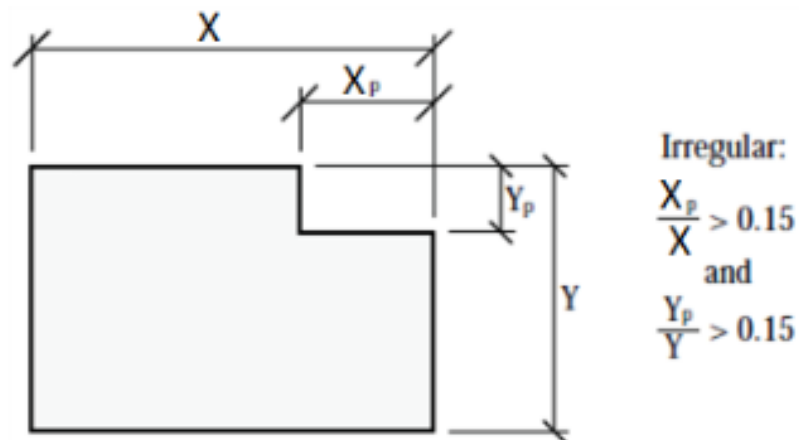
Esquema de irregularidad por entradas en planta (ASCE 7 2010)
